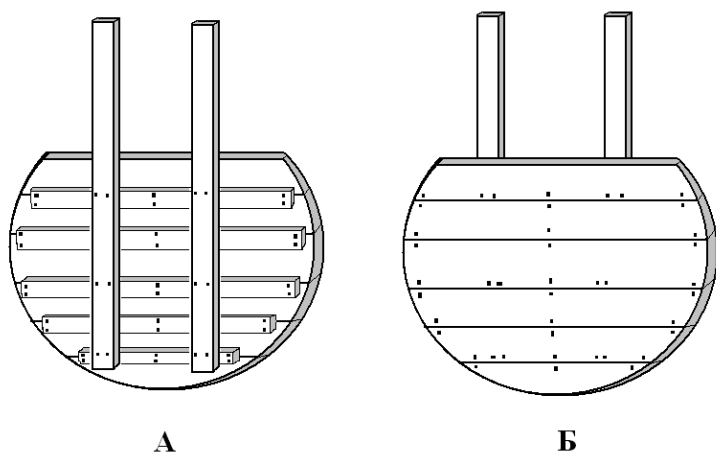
Деревянные щиты для частичного перекрытия стока воды через трубы бетонных переездов на торфополях урочища «Бублик»: А – внешняя сторона, Б – внутренняя, прилегающая к краям трубы.
